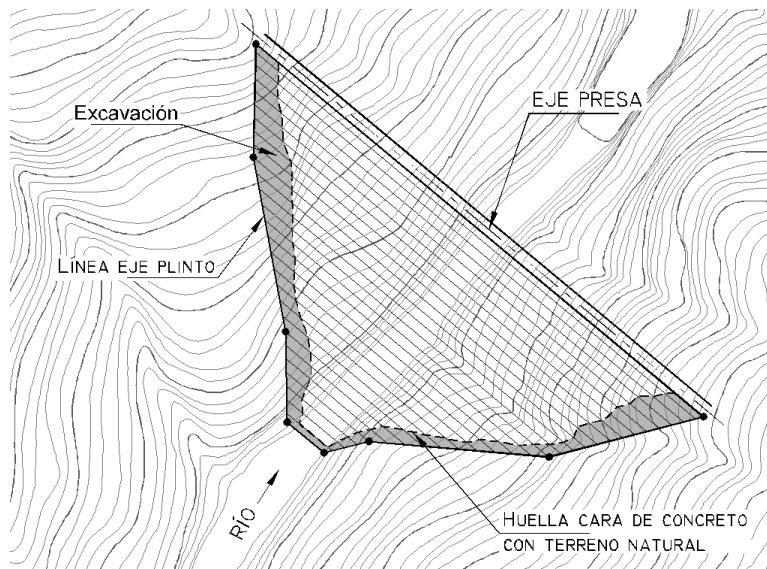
Contacto entre laderas y plano de la cara de concreto. Cortesía C.F.E.
